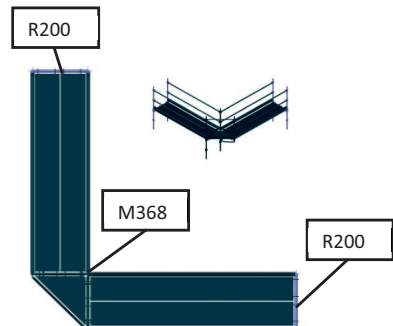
Angle à 2 poteaux avec plateau d'angle en extérieur reposant sur console en départ
